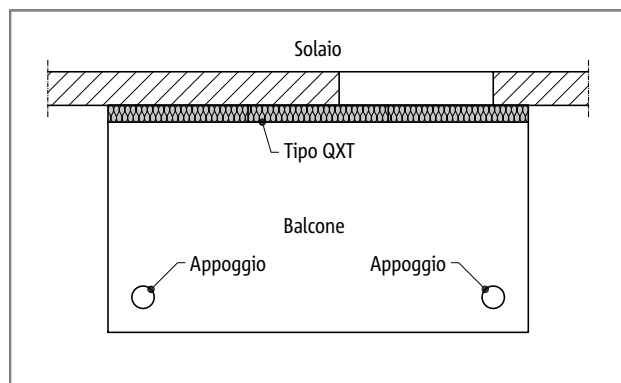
Schöck Isokorb® tipo QXT: balcone con appoggio su pilastri
